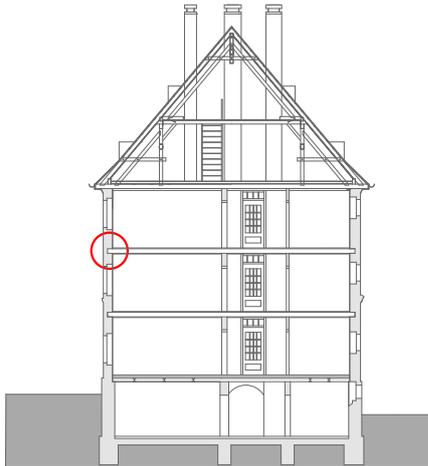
Deckendetail Bestandssanierung mit Innendämmung
